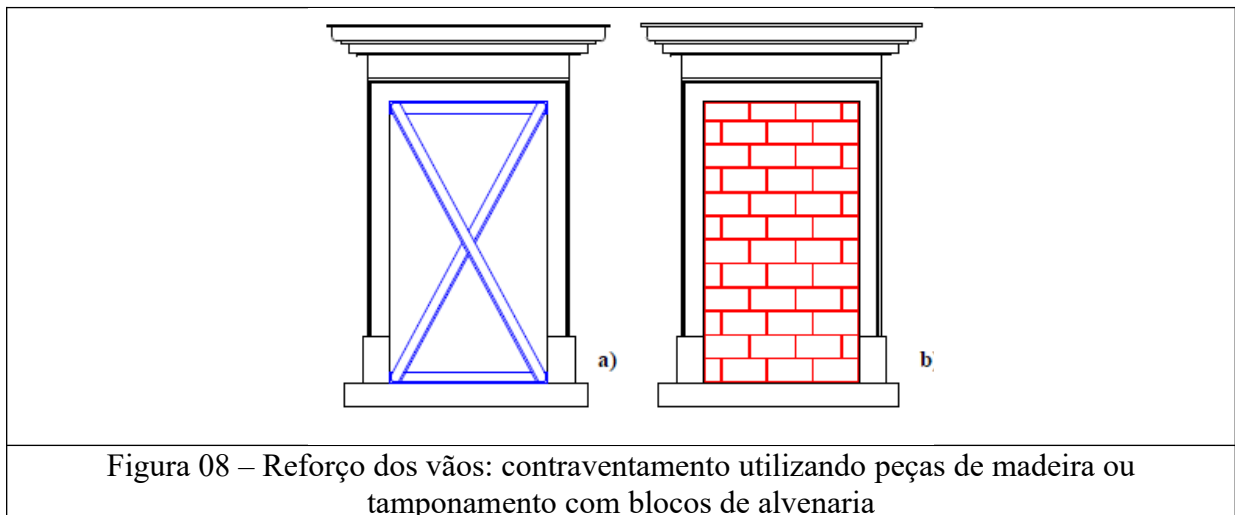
Reforço dos vãos: contraventamento utilizando peças de madeira ou tamponamento com blocos de alvenaria
